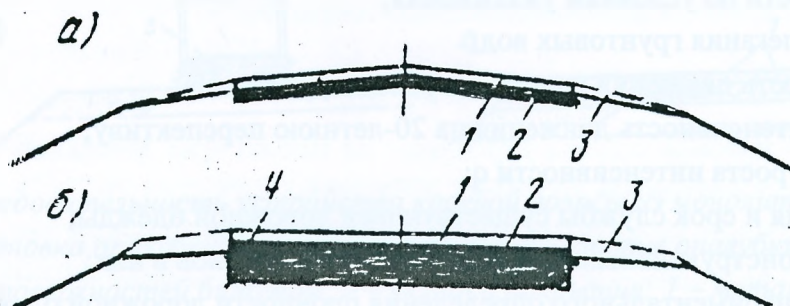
Схема усиления старой дорожной одежды без уширения: а – укладка нового покрытия на всю ширину старой дорожной одежды; б – то же, после укладки по краям слоев для смягчения поперечного уклона; 1 – новое покрытие; 2 – старая одежда; 3 – поднятая и укрепленная обочина; 4 – слой, смягчающий поперечный уклон.
